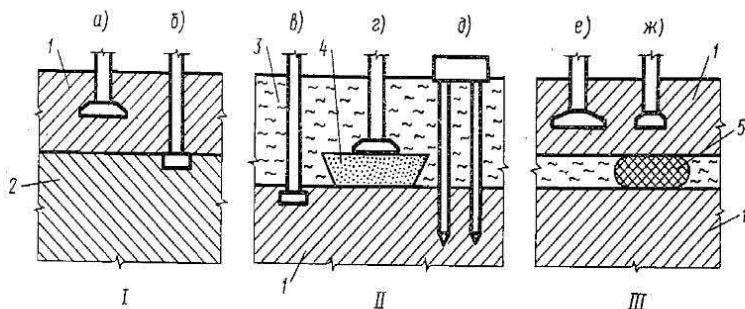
Схемы напластований грунтов с вариантами устройства фундаментов:
